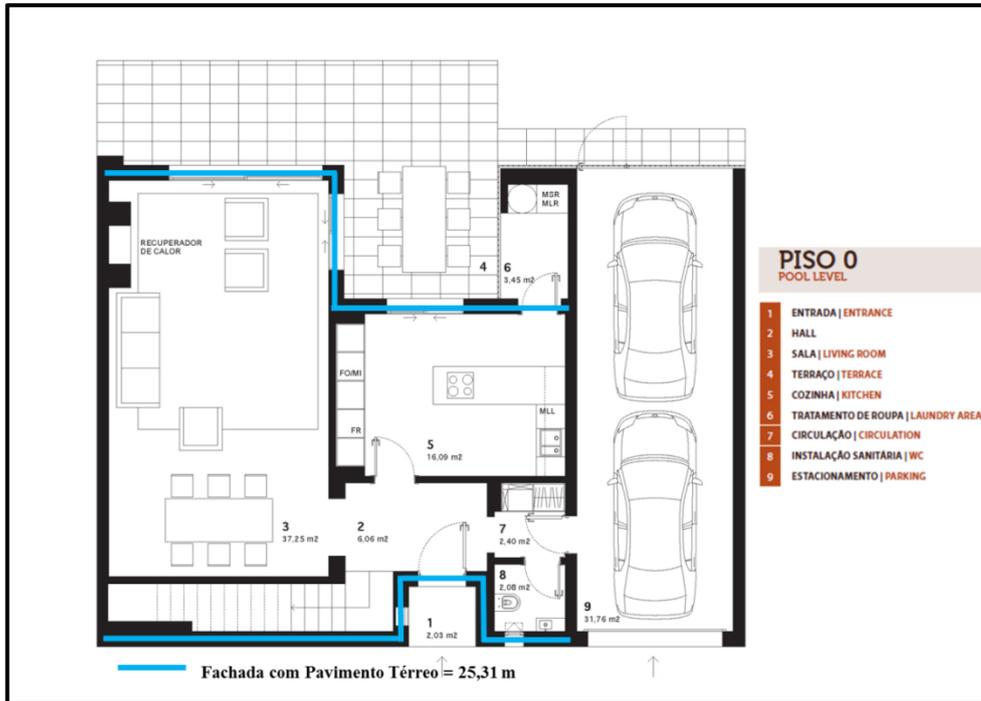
PTL – Fachada com Pavimento Têrreo
